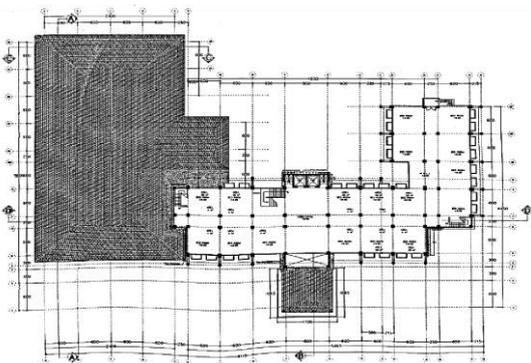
Denah Lantai 2 Gedung Training Center Unima
